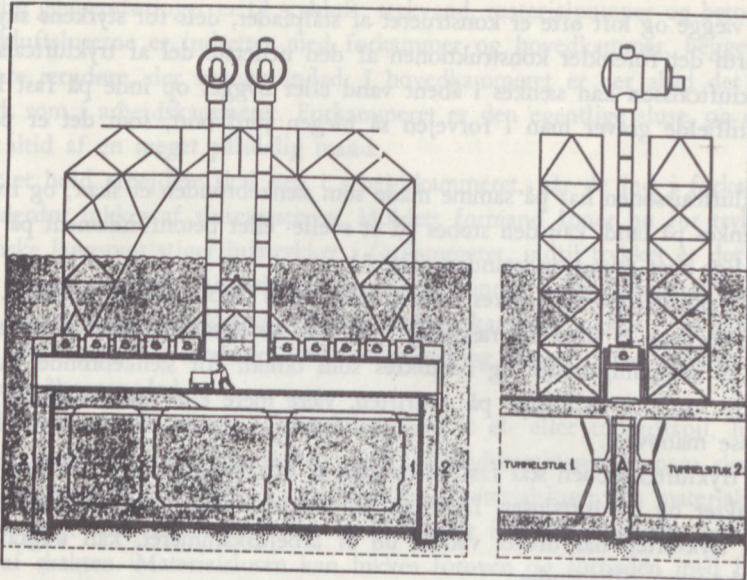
Dykkerklokke over en fuge mellem to tunneldele.
